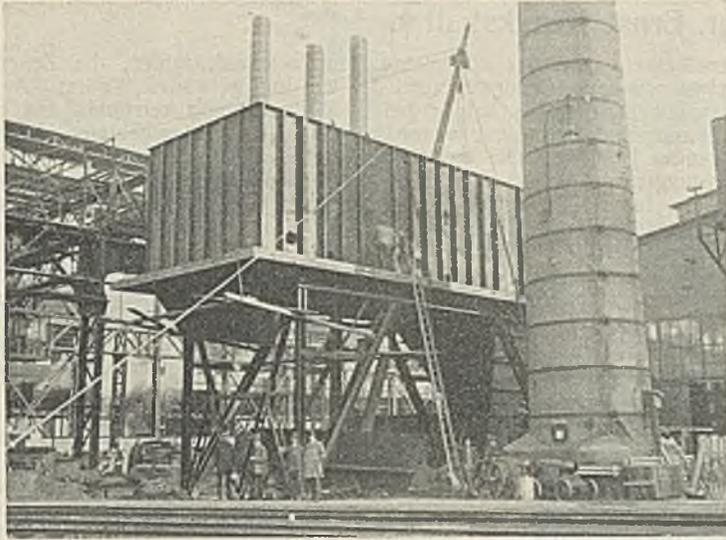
Montage des Bunkerkörpers auf der Tragkonstruktion.
